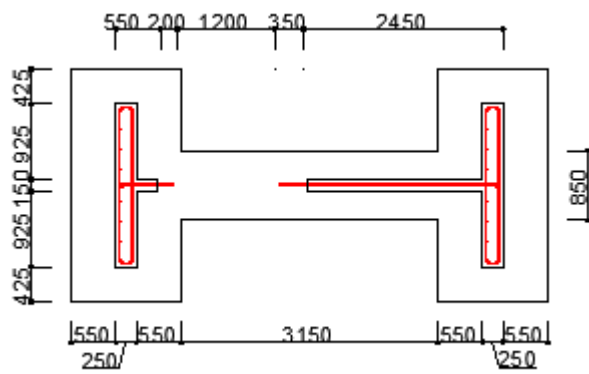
試験体配筋図 (開口設置前) (単位: mm)
